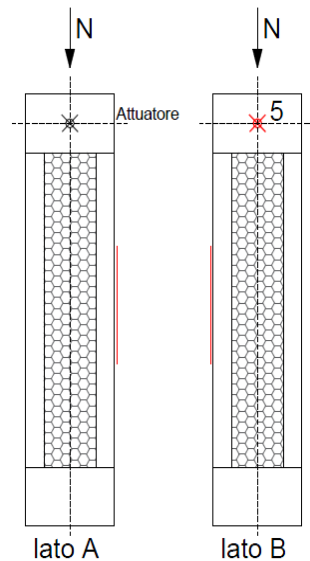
Disposizione dei trasduttori sulle facce fronte e retro, lato A e lato B del provino
